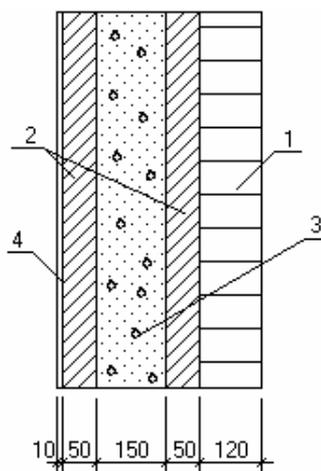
Устройство наружной монолитной стены из несъемной опалубки из ППС
